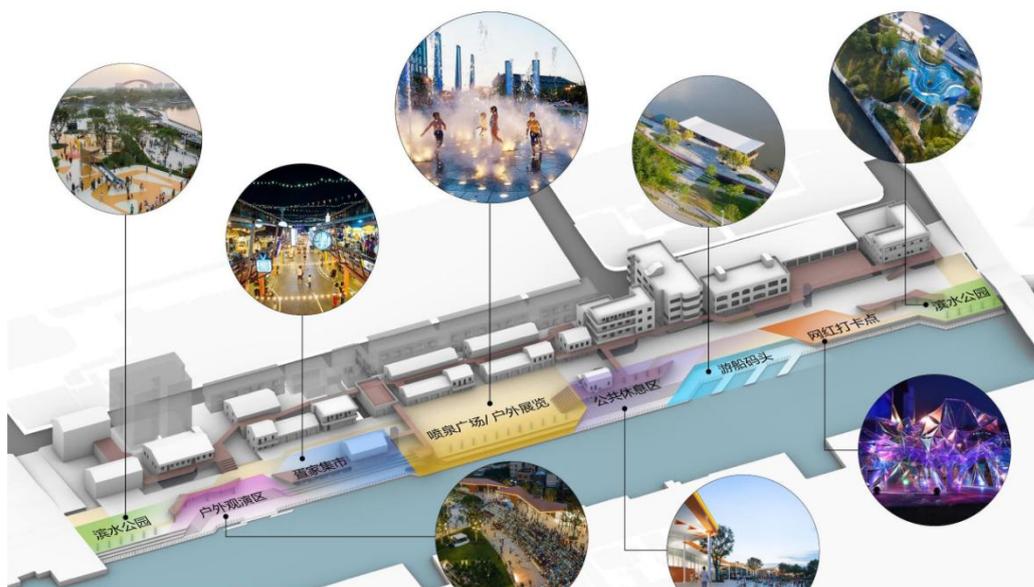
300 米水岸迎客厅文旅中心工程总平面图
